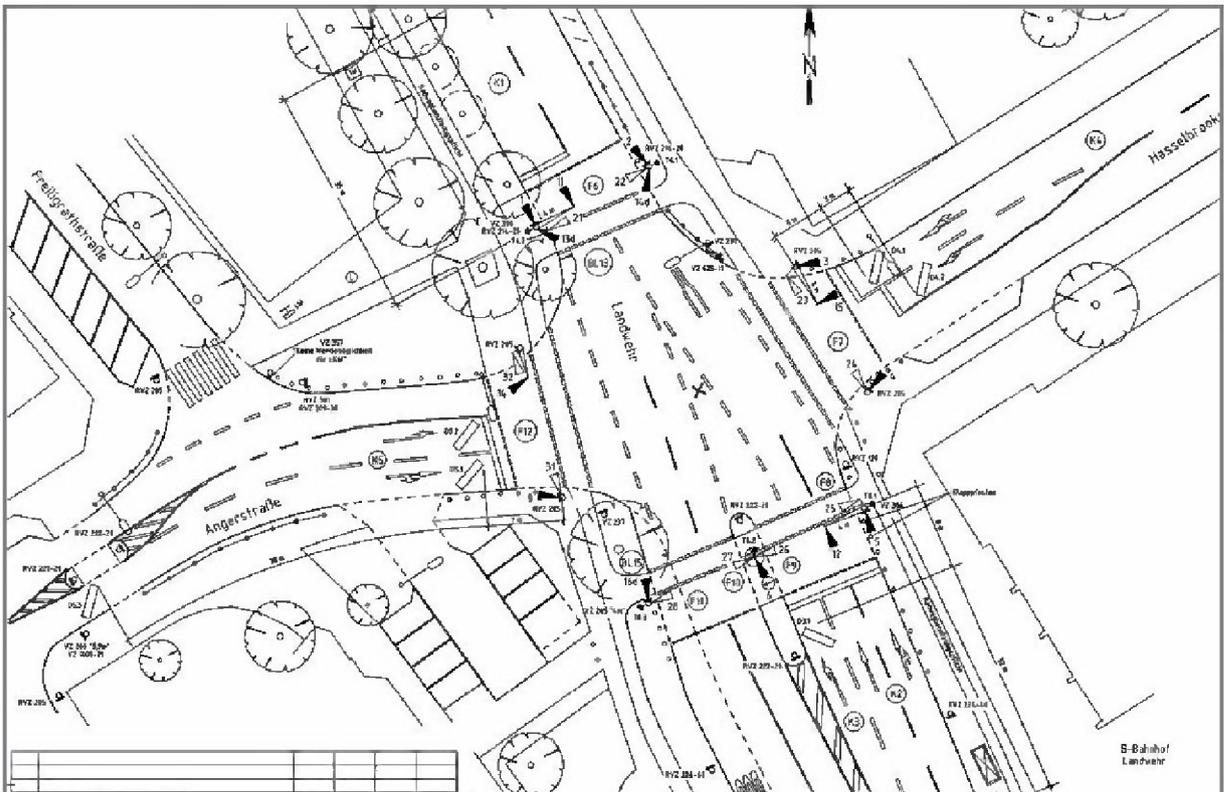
2 Signallageplanausschnitt LSA 169
